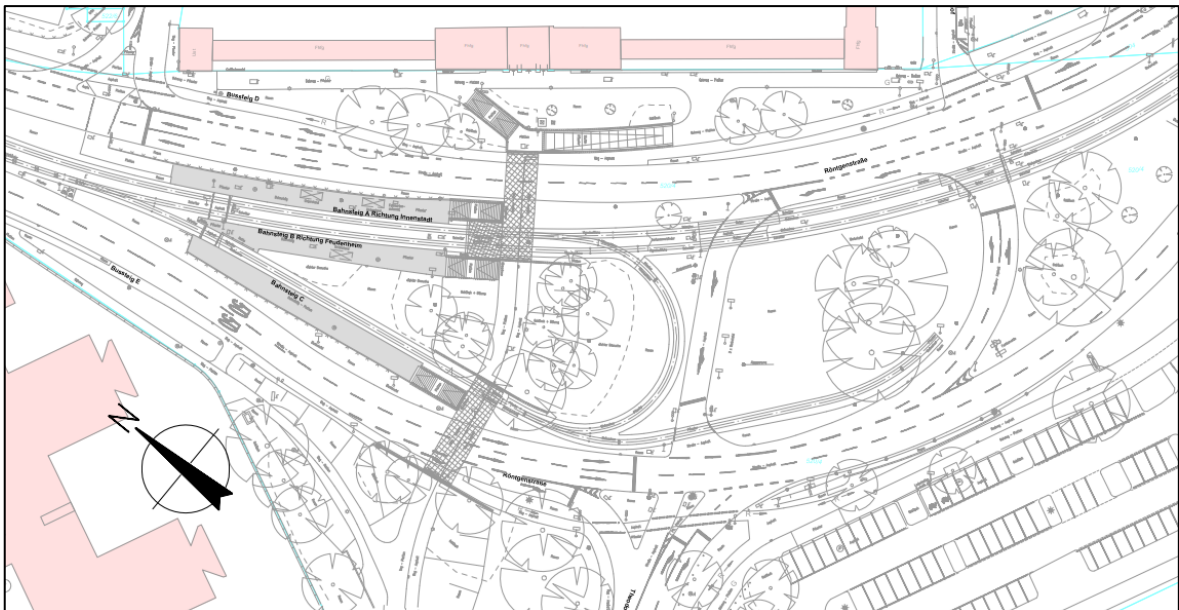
Lageplan Bestand der Haltestelle des Hauptfriedhof Mannheims (Quelle: Obermeyer Infrastruktur, Karlsruhe)
